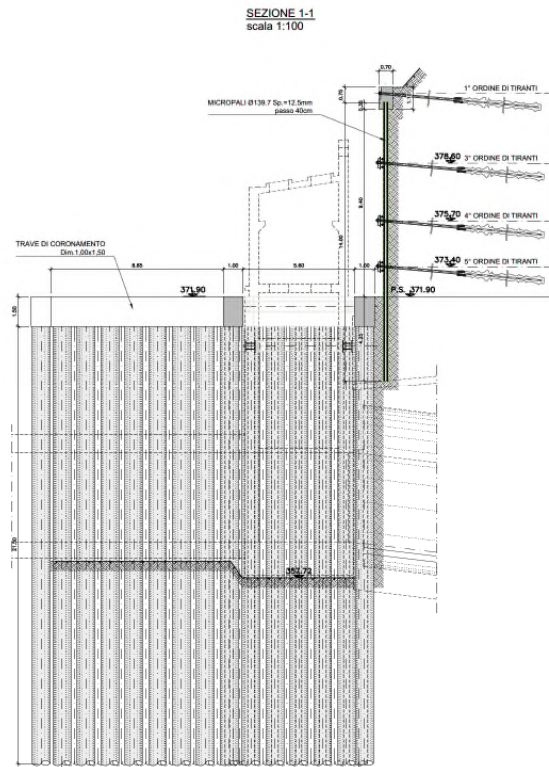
Pali tipo “C1”-“C2” – Pianta e sezione
